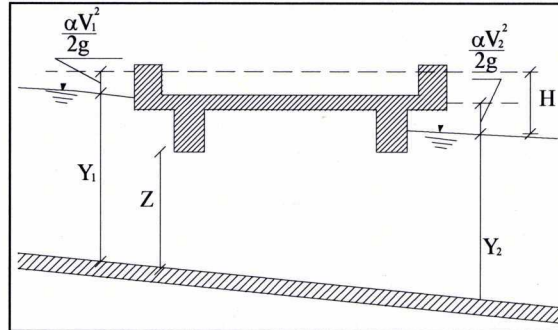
Sezione schematica di un ponte – Schema di calcolo
